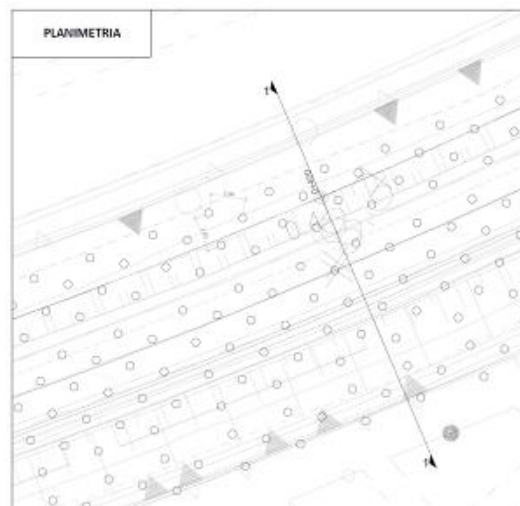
Esempio pianta tipo con colonne di deep-mixing
